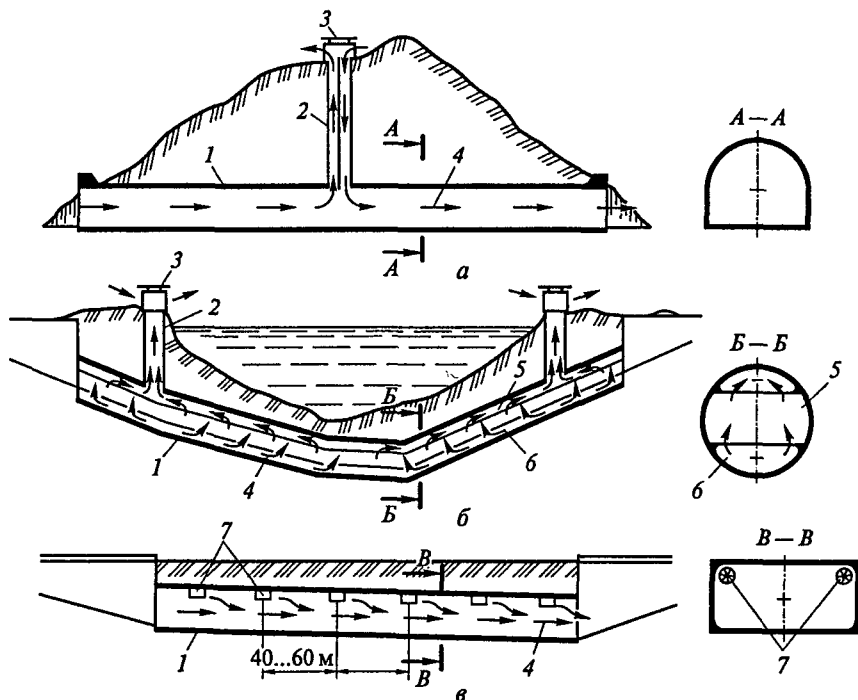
Системы искусственной вентиляции автодорожных тоннелей: а — продольная; б — поперечная; в — продольно-струйная; 1 — тоннель; 2 — шахтный ствол; 3 — вентиляционный киоск; 4 — направление движения воздуха; 5 — вытяжной канал; 6 — приточный канал; 7 — струйные вентиляторы
